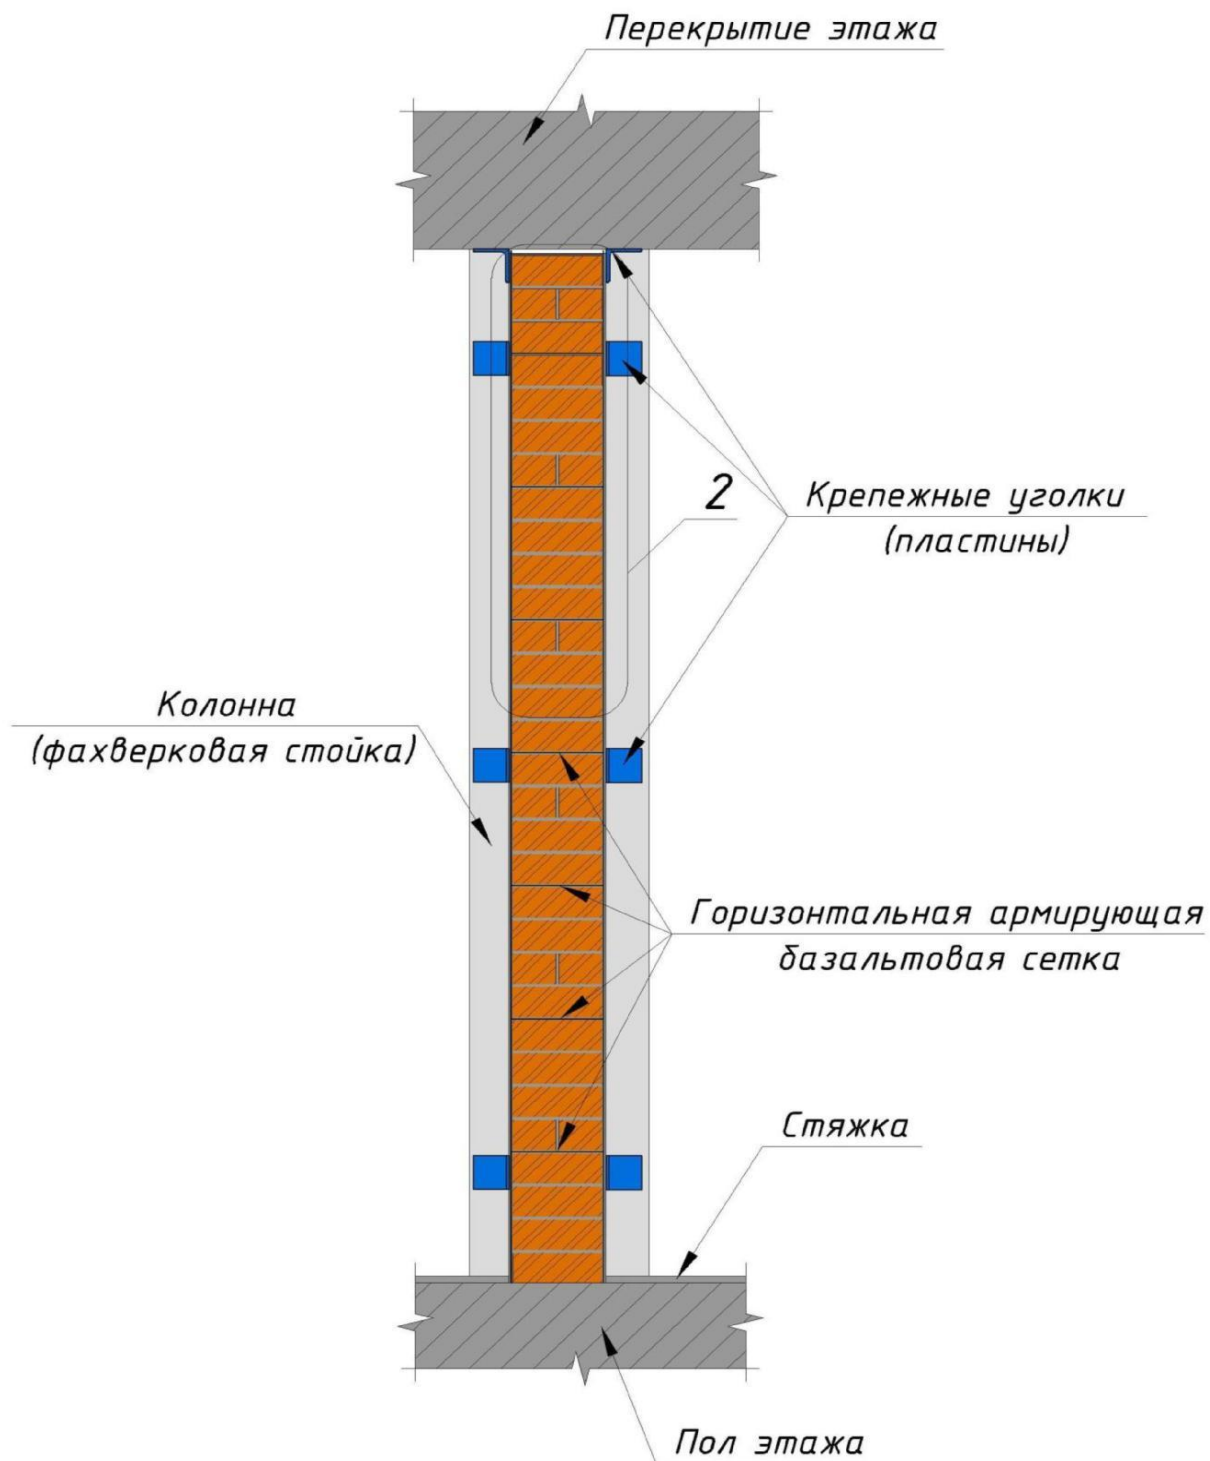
Схема крепления кирпичной перегородки, усиленной базальтовой сеткой, к каркасу здания(при толщине перегородки 25см)
